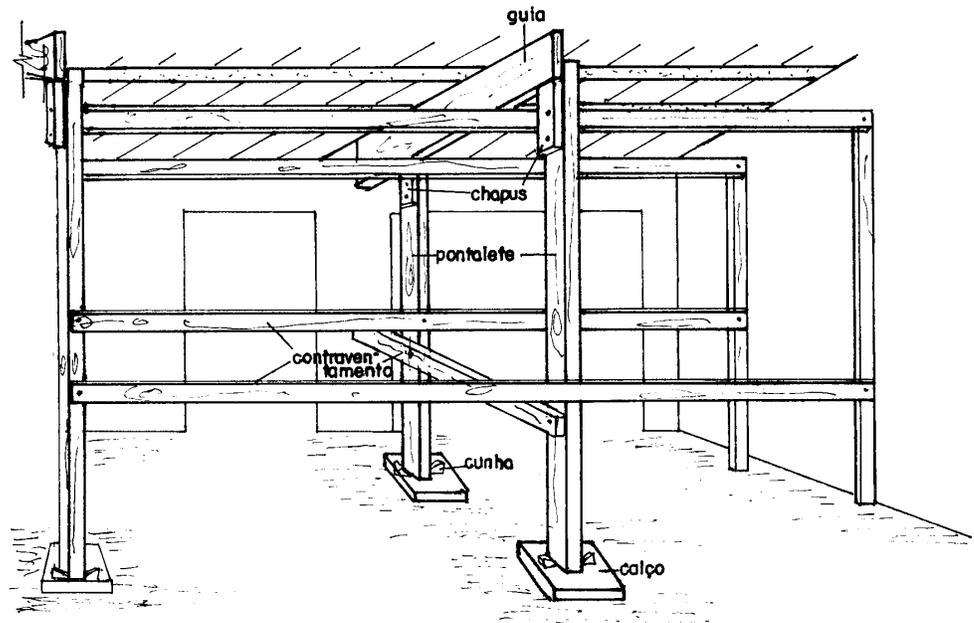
Exemplo de escoramento convencional para laje pré-fabricada
